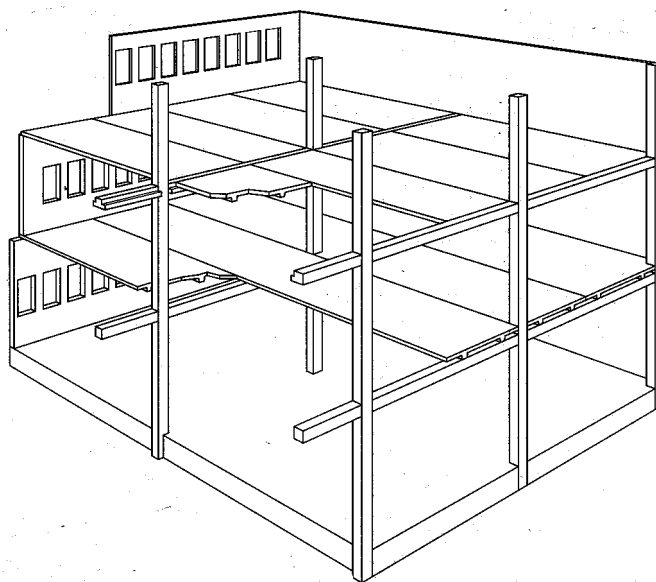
Schematische voorstelling van een kantoorgebouw met skeletconstructie en gevels in architectonisch beton
